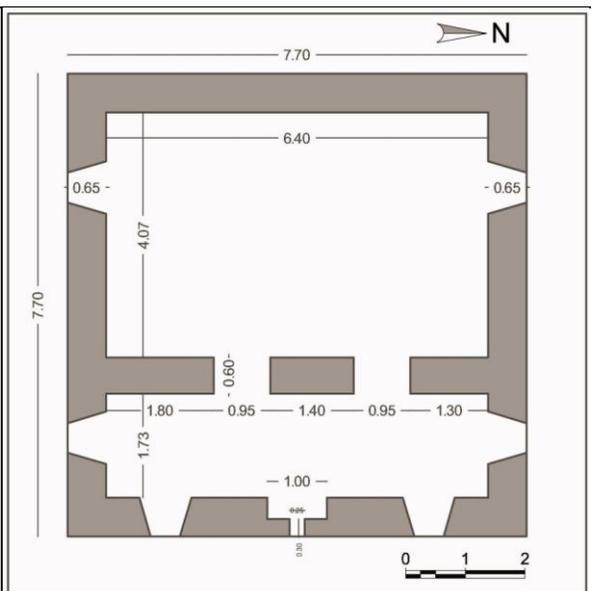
أطم (حصن) بن عميره: مسقط أفقي للطابق الأول.
